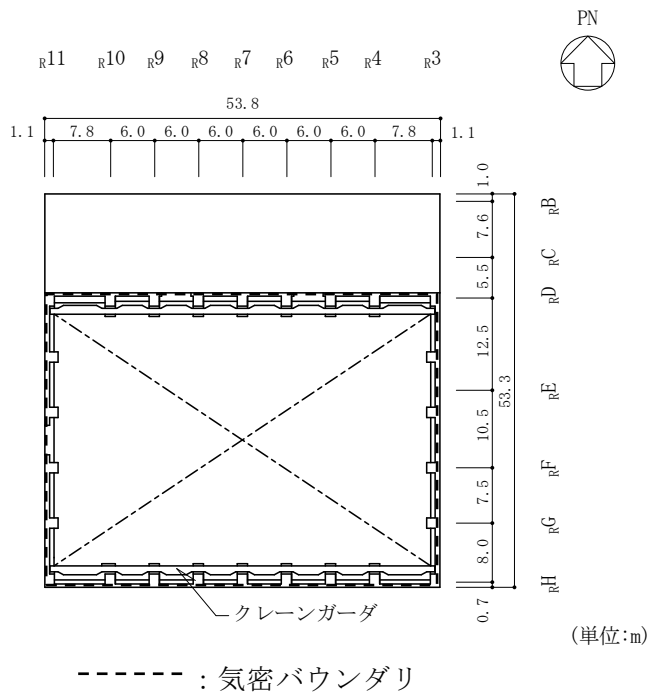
(8) 原子炉建物原子炉棟（二次格納施設）の概略平面図（EL 51.7m）
